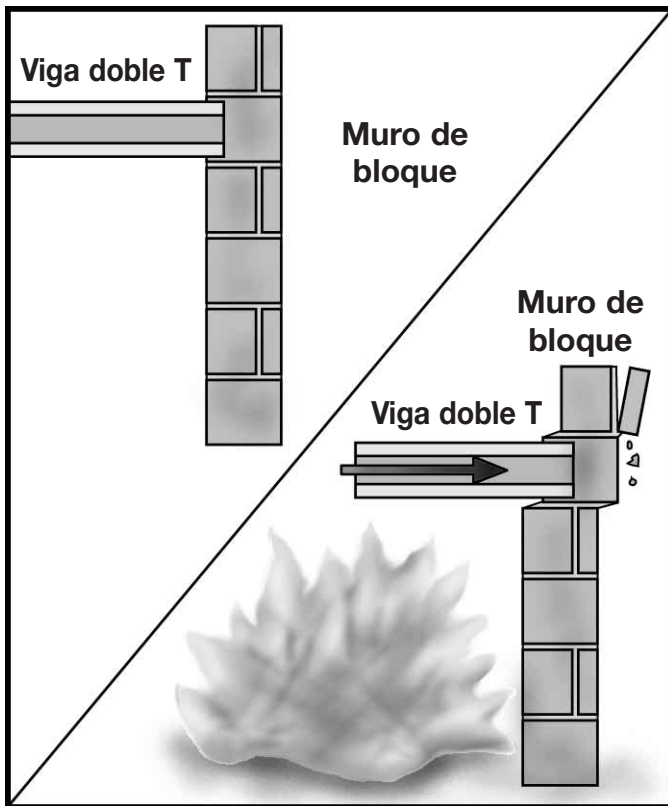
A medida que las vigas se dilatan, pueden empujar un muro y provocar un hundimiento.
